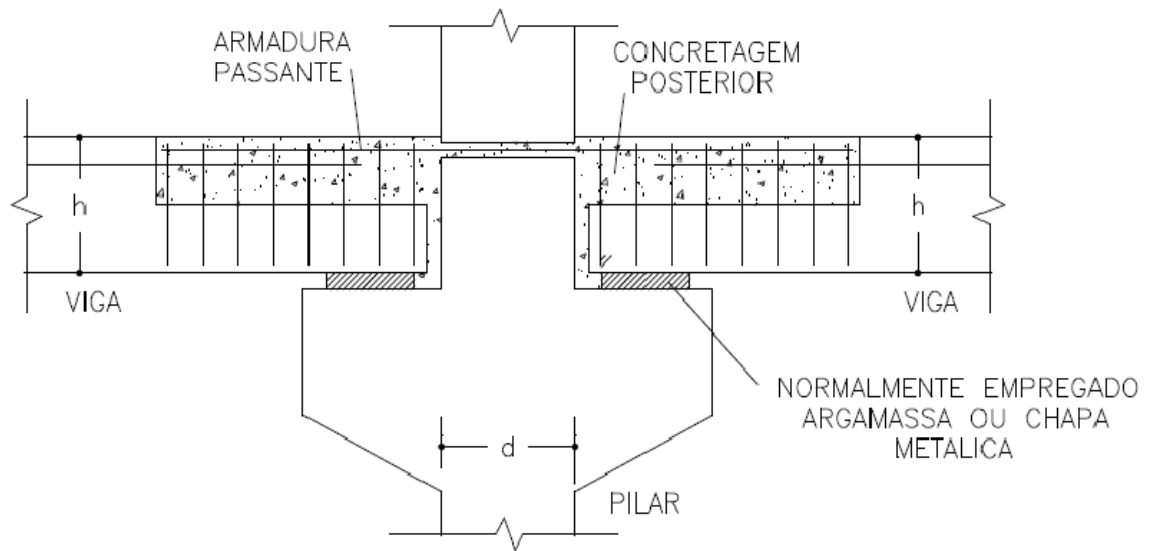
Ligação Rígida Pilar-Viga de Extremidade.
